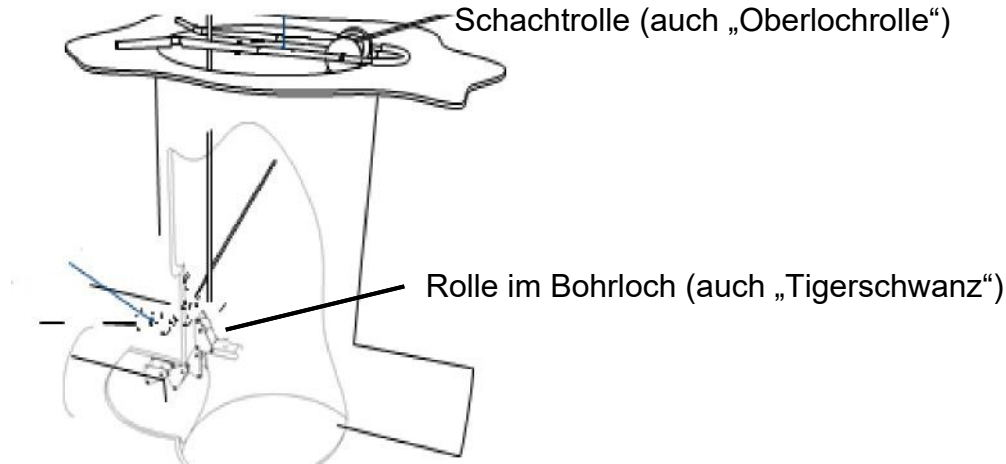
Verwendung von Rollen zur Reduzierung des Kabelverschleißes
